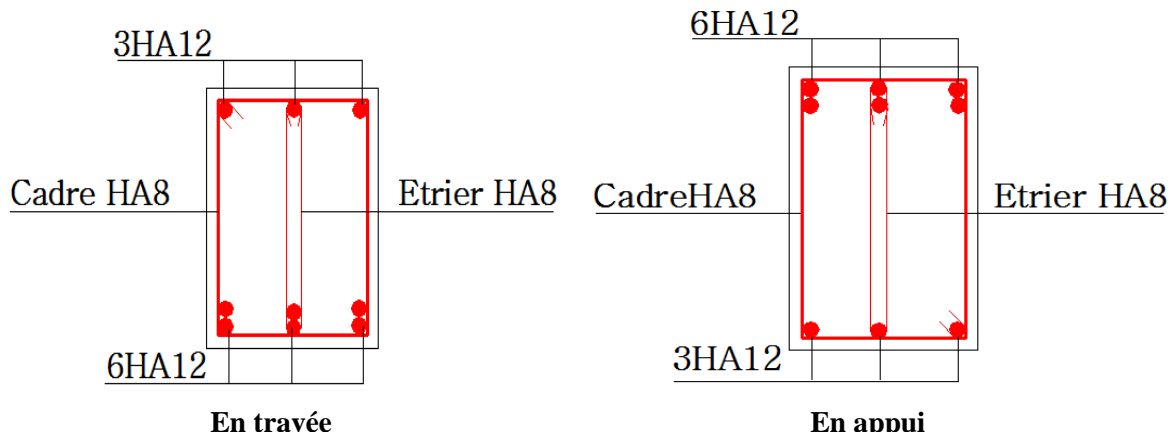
Schémas de ferrailage des poutres secondaires de la terrasse.
